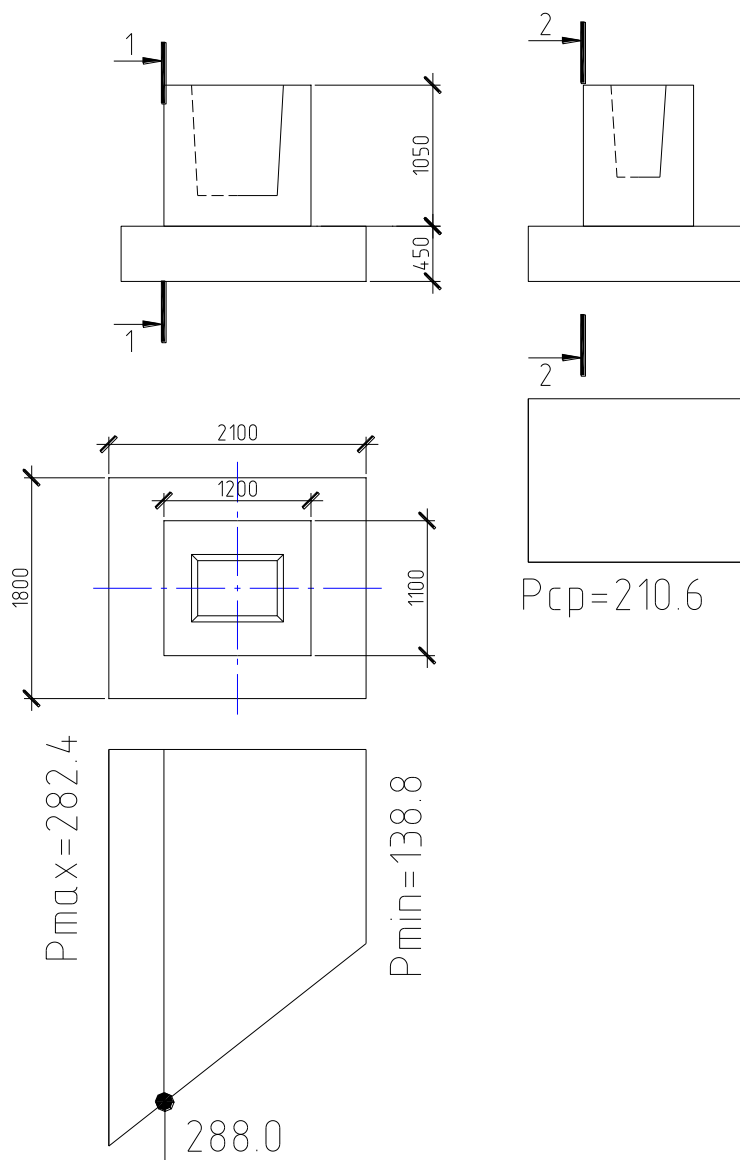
К расчету монолитного столбчатого фундамента под колонну
